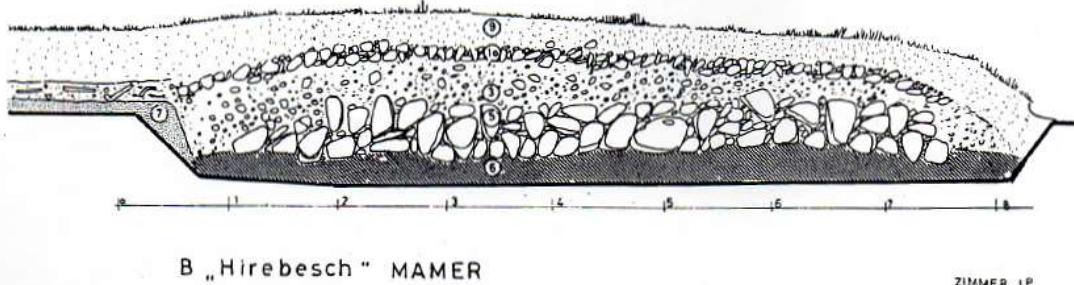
Coupe de la chaussée à Mamer (Grand-Duché de Luxembourg)
